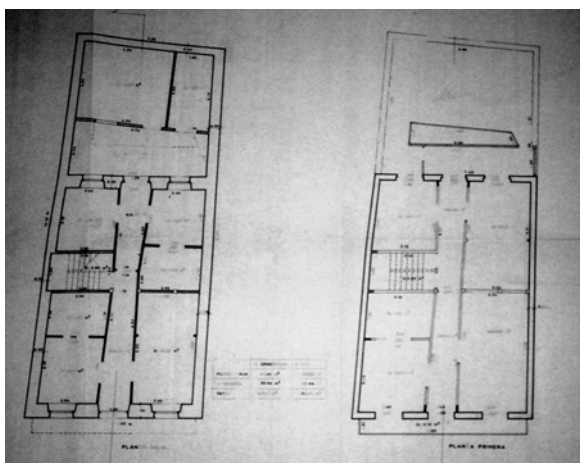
Casa Dorado Montero: plantas baja y primera, por A. y L. Ferreira, 1989.
